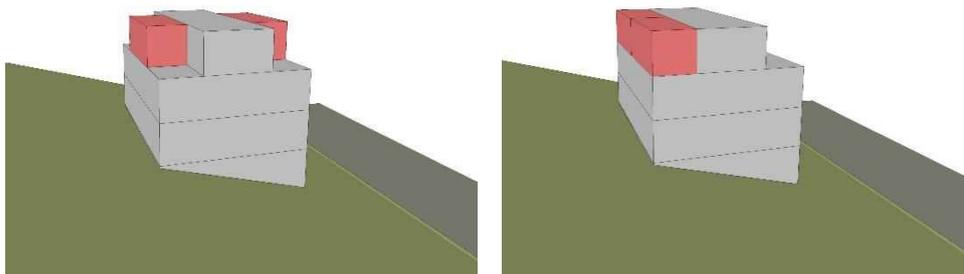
«Reguläre» Anordnung der Dachaufbauten beim Attikageschoss (links) sowie komplette hangseitige Anordnung der Dachaufbauten (rechts) (Quelle: EBP)
